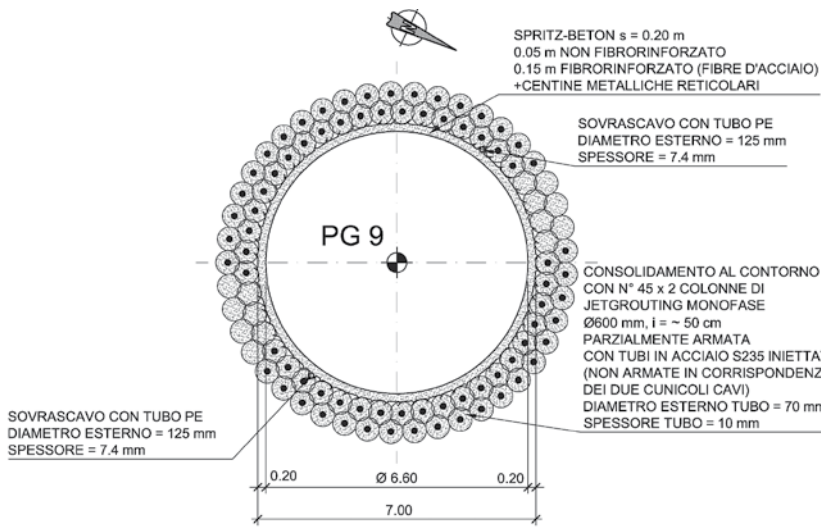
Sezione tipo SP1 in fase di realizzazione profondità inferiore ai 60 m
